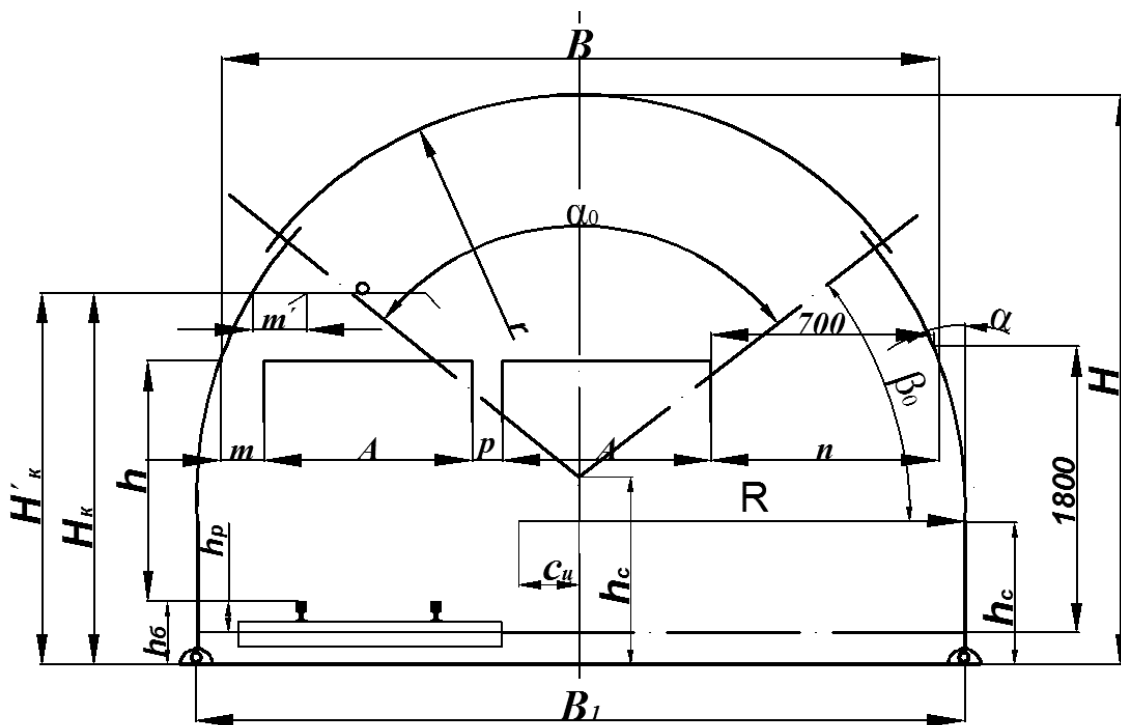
Схема к расчету сечения выработки с металлической арочной податливой крепью из спец. профиля
